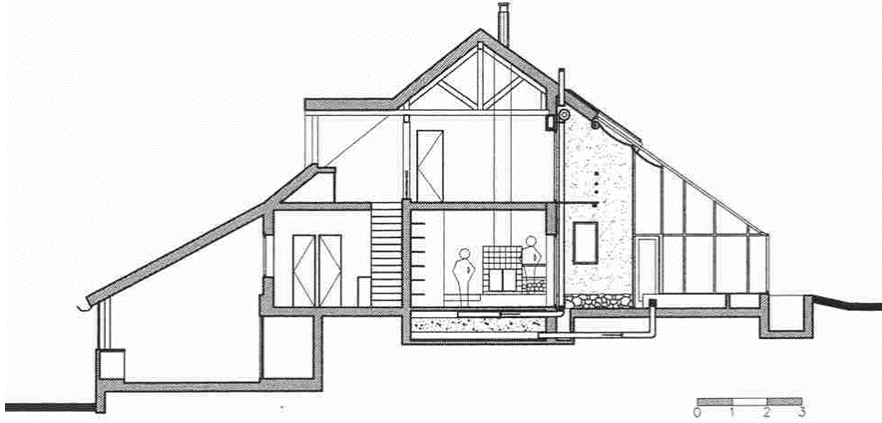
Corte Norte-Sur con invernadero, lecho de piedra para almacenamiento de calor bajo el piso, estar en planta baja y sala de juegos con dormitorios en planta alta.
